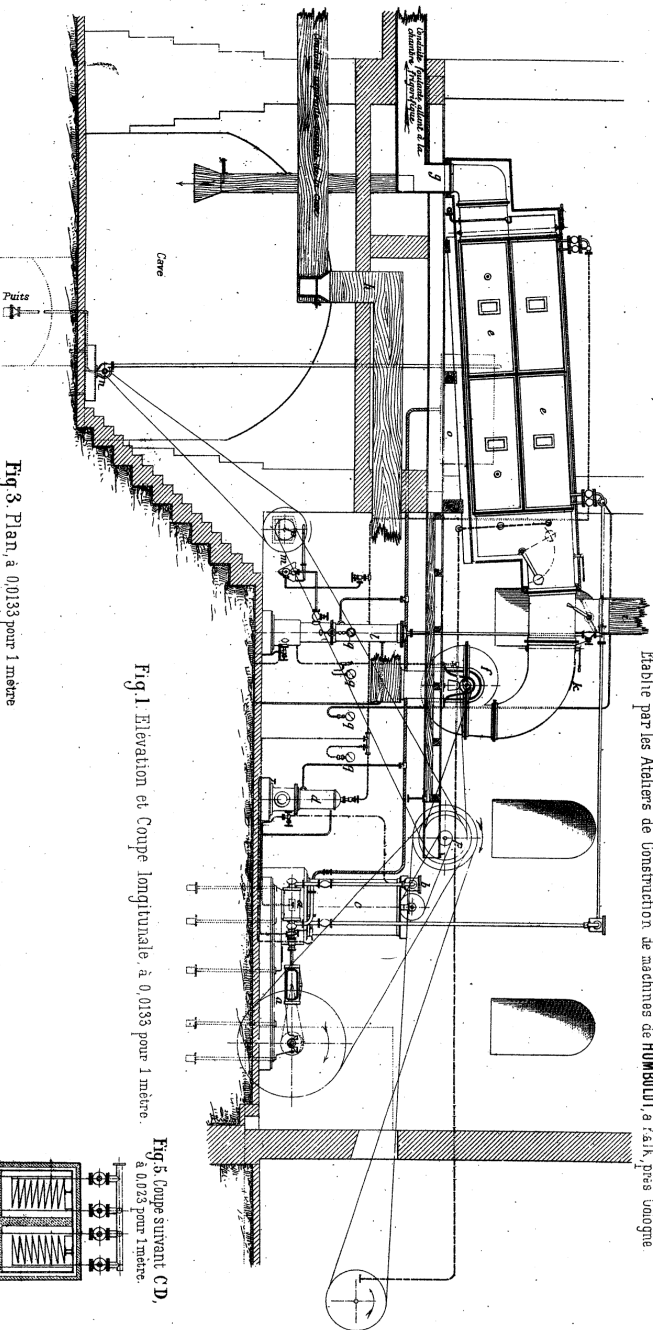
Elevation et Coupe longitudinale, à 0.0133 pour 1 mètre.
